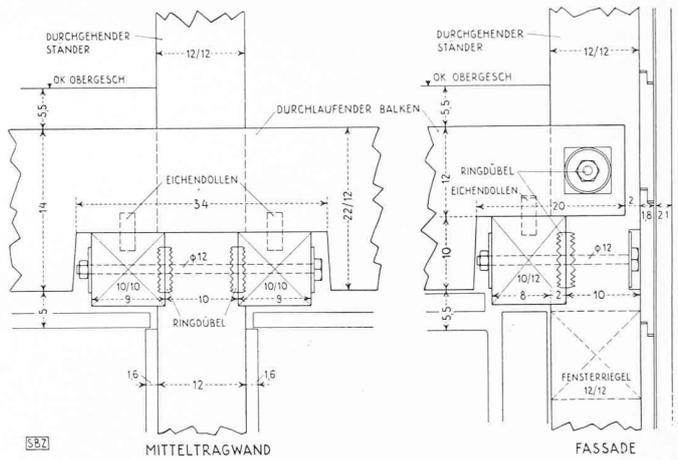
Anschluss der Balken an die durchgehenden Ständer; Detail 1:10
